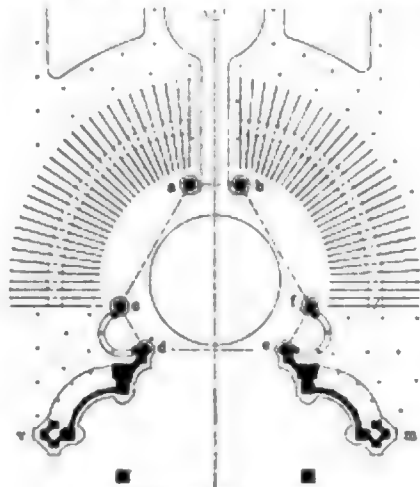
Grundriss der Haupteingangshalle.
